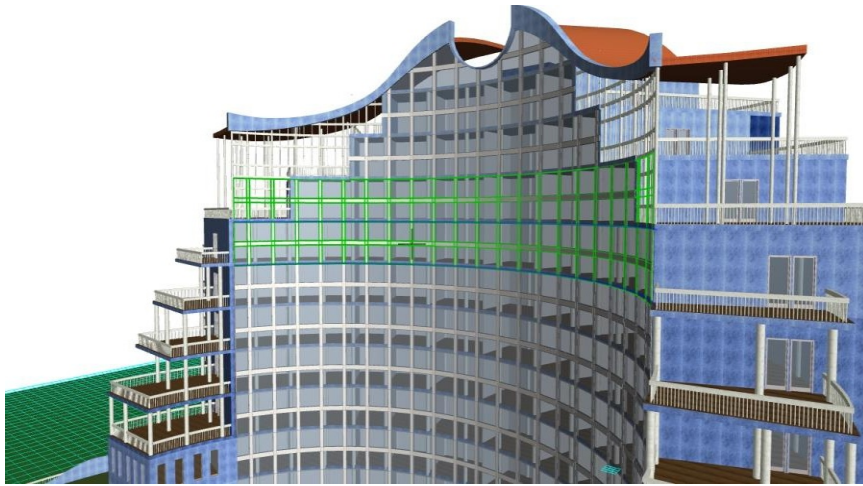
Елементи фасадного скління окремих поверхів зі зменшенням площі перерізу з 10-12 поверхи
